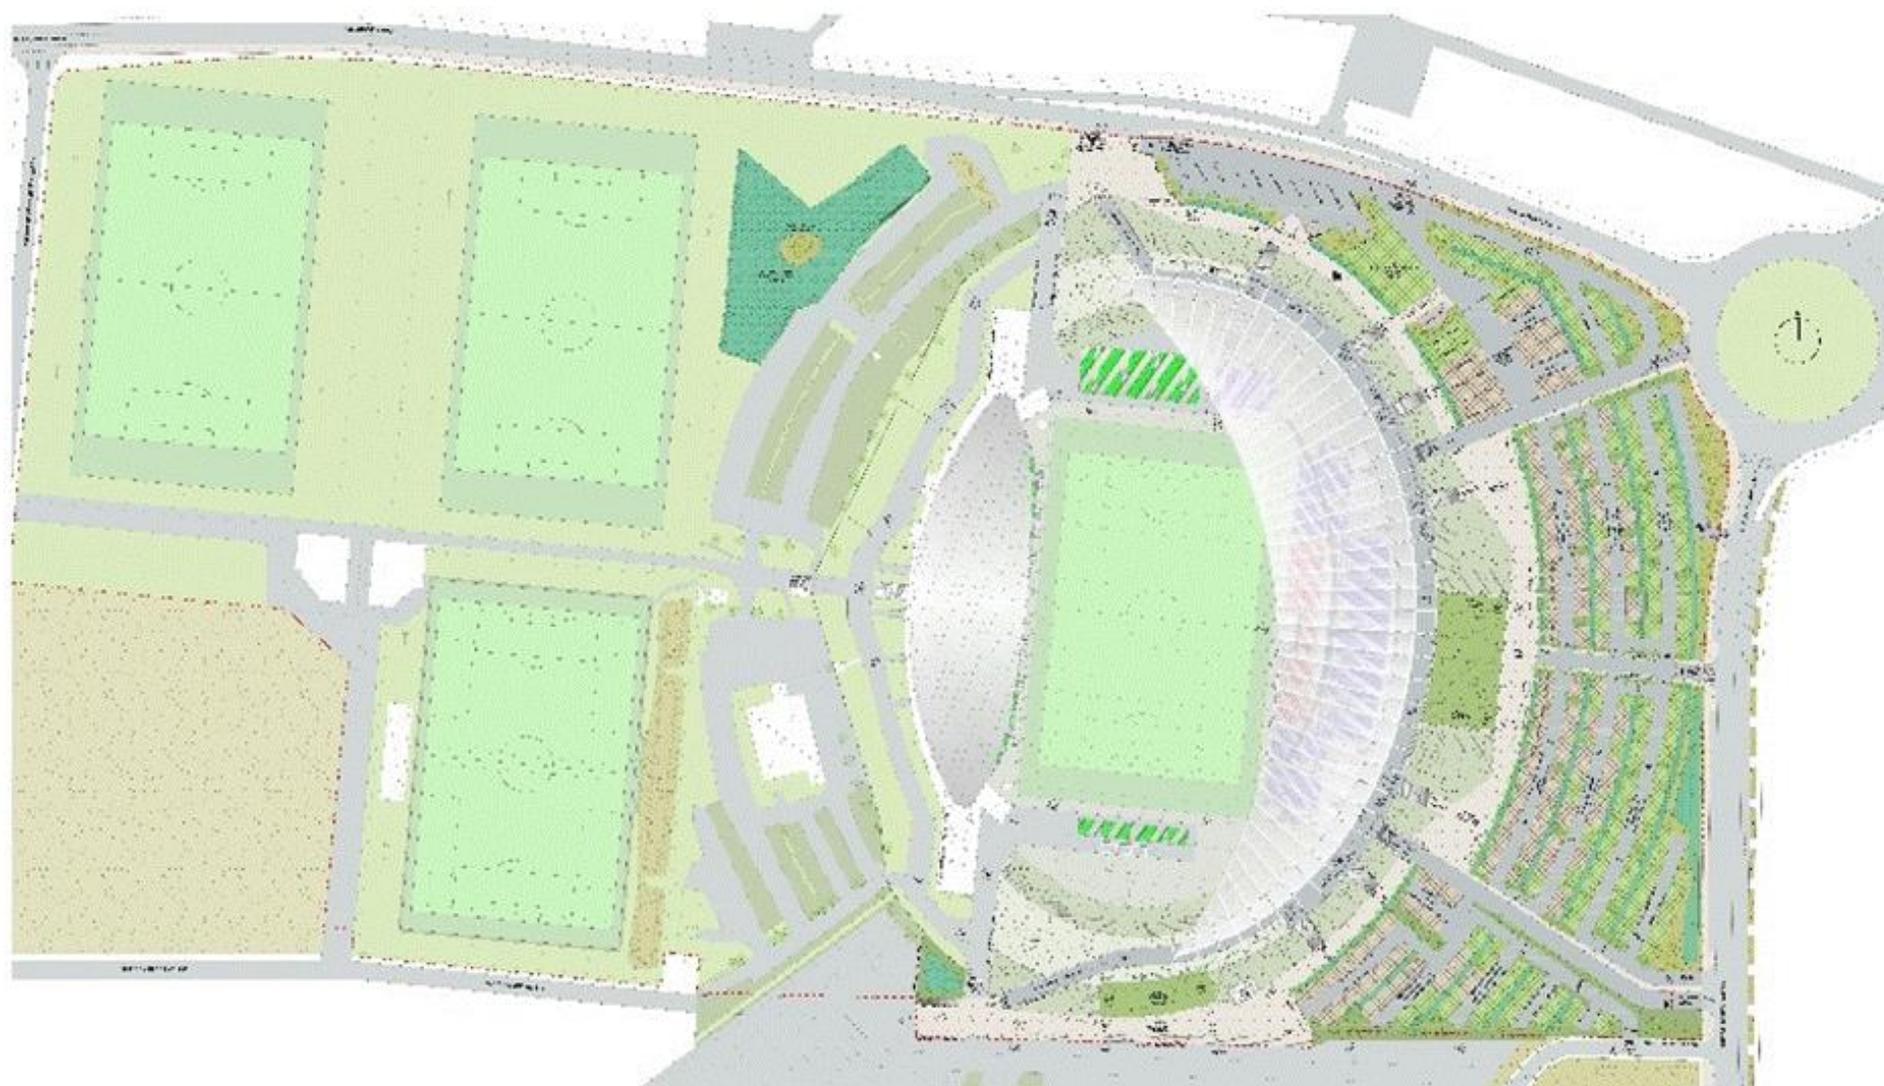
Plan masse du projet de tribune Est et d'aménagements extérieurs
